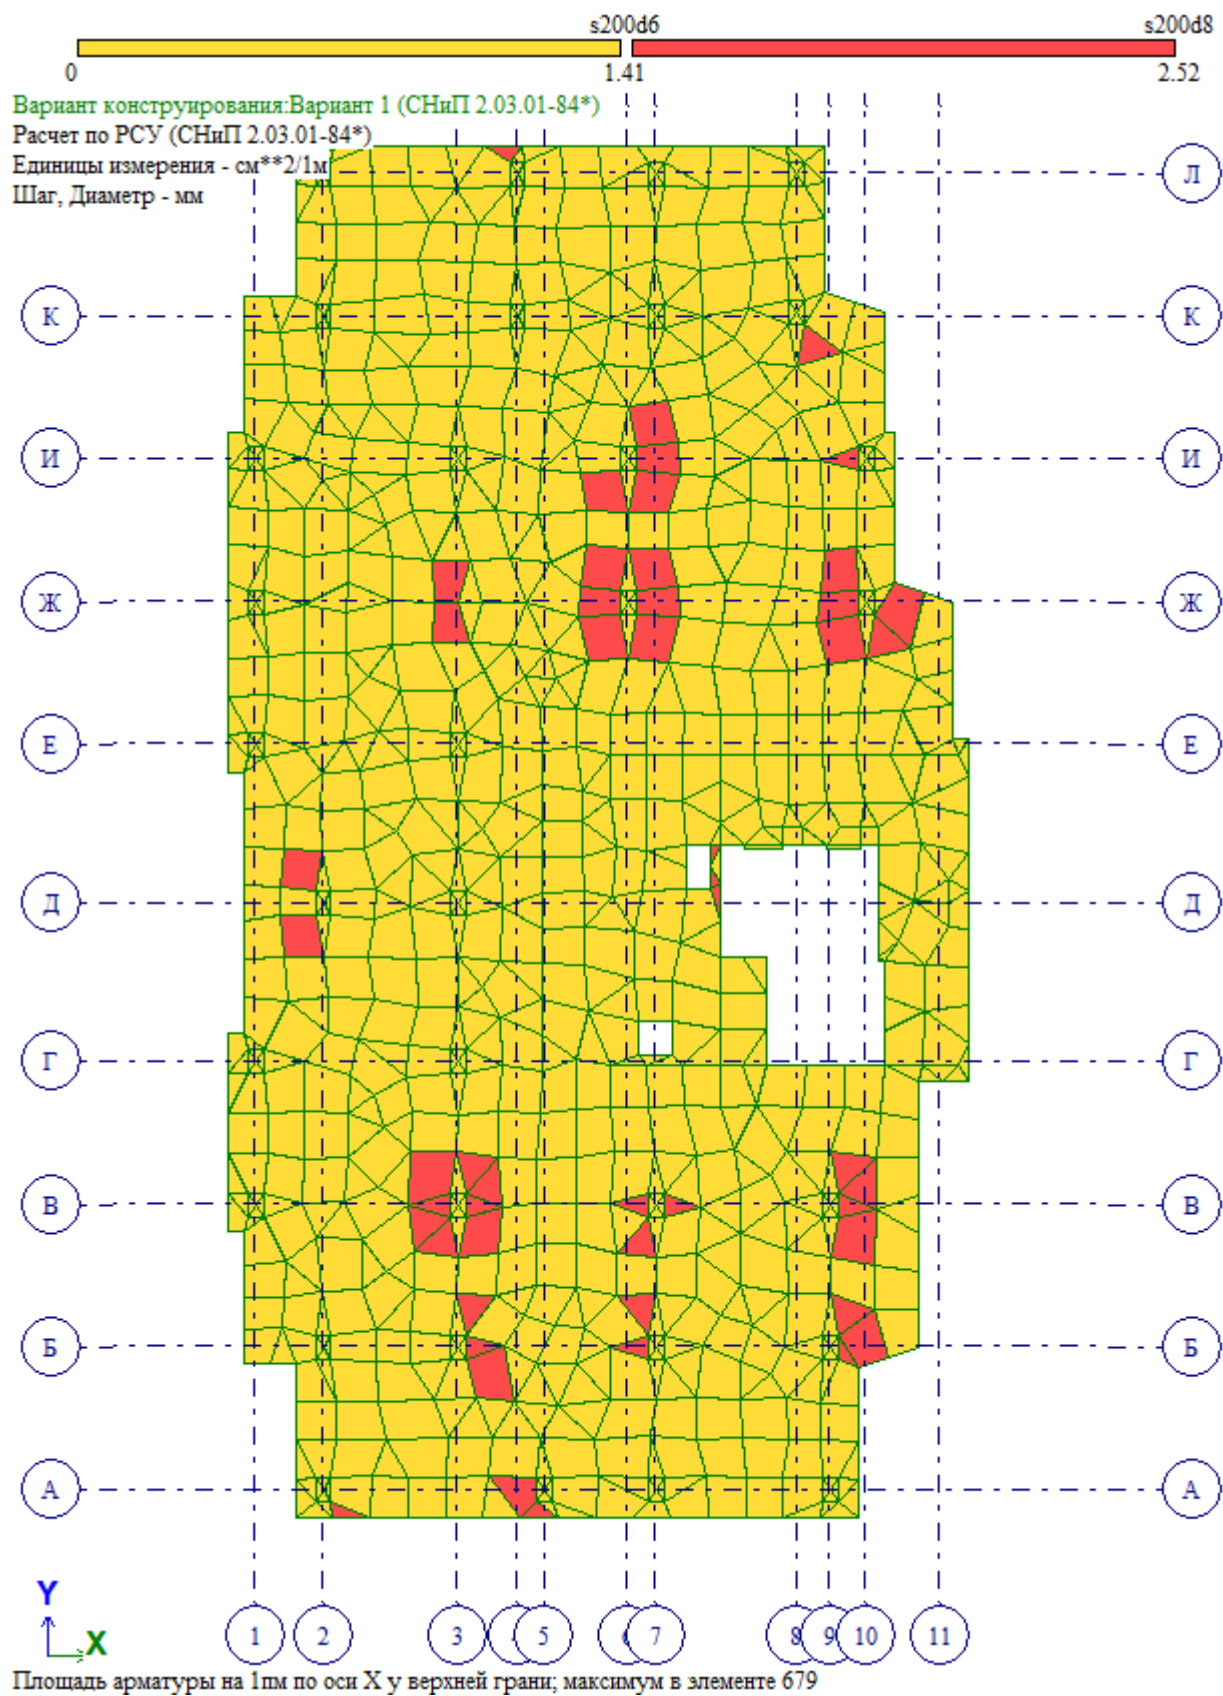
Площадь верхней арматуры вдоль буквенных осей.
